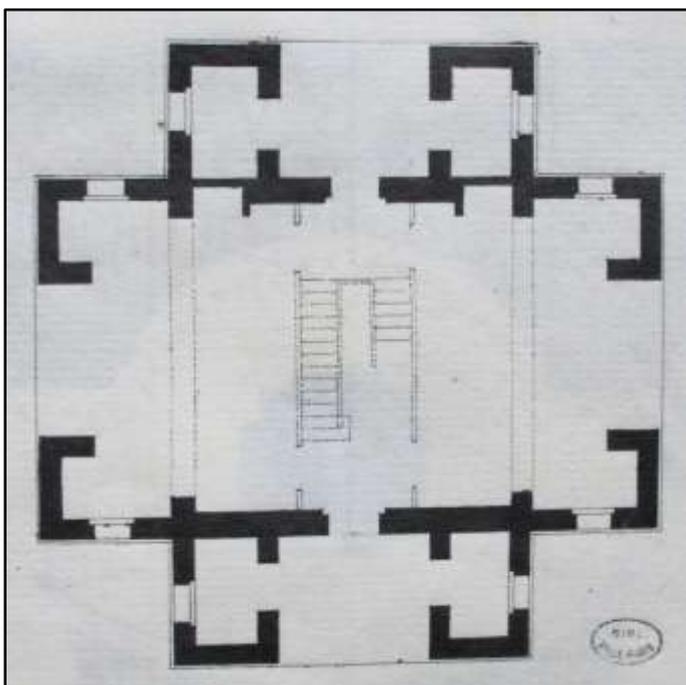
Plan du rez-de-chaussée des guérites de part et d'autre de la route de la Villette.
